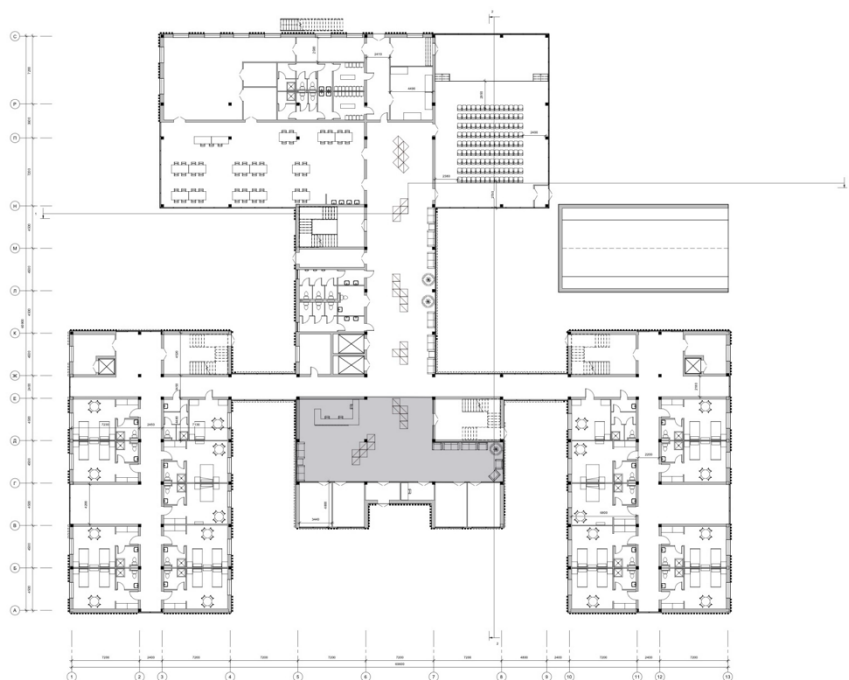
Розміщення на плані поверху запроєктованої будівлі
